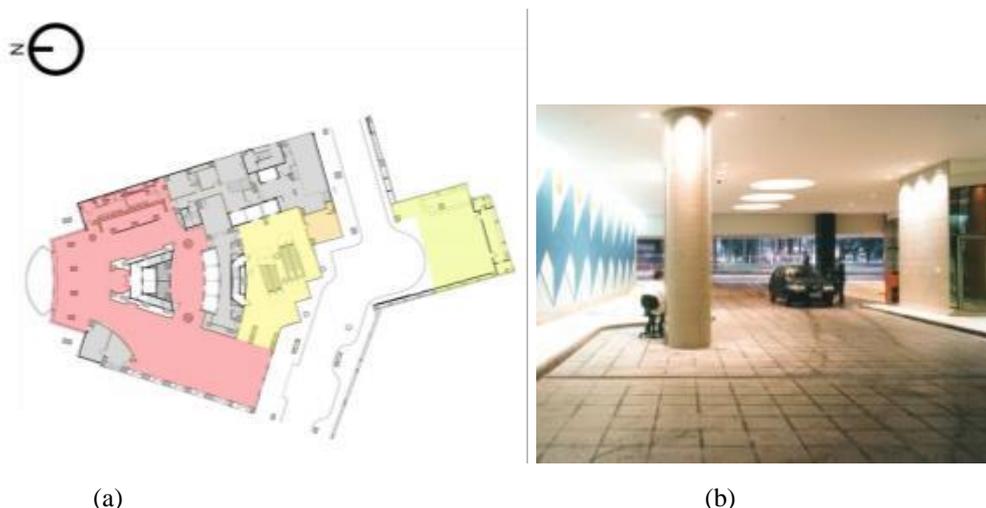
(a) Planta do Pavimento Térreo do Edifício “O Estado de São Paulo”, conforme projeto de Juliano e construção em 2004. Rua interna destacada em Branco. Legenda: Áreas de Apoio (Cinza); Lobby de Convenções (Amarelo); Lobby (Vermelho); Sala de computadores (Laranja); e Confeitaria (Verde). (b) Tomada geral para a rua interna do Hotel Jaraguá, destaque da proposta de *retrofit* de Juliano, com painel artístico concebido pelo próprio Juliano a direita, e o *lobby* a esquerda. Fontes: (a) MELACHOS, Felipe. 2013. 1 planta. (b) JULIANO, 2006, p. 61.
